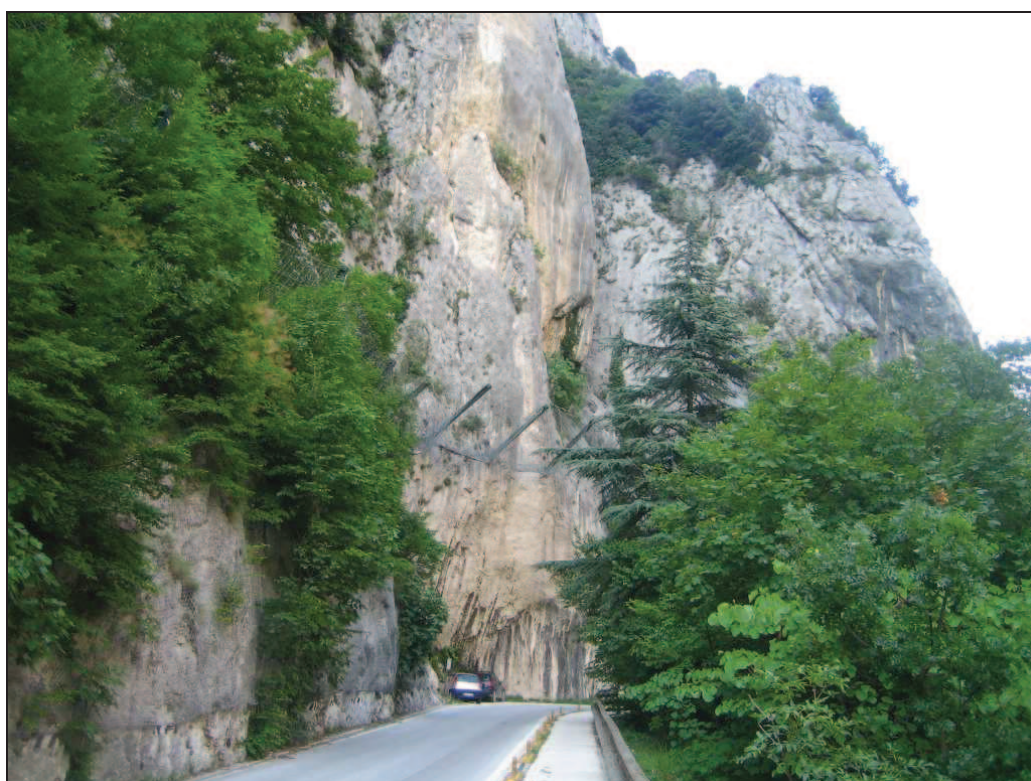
Barriera paramassi, pannelli di rete in fune d'acciaio e reti paramassi all'uscita della galleria.
